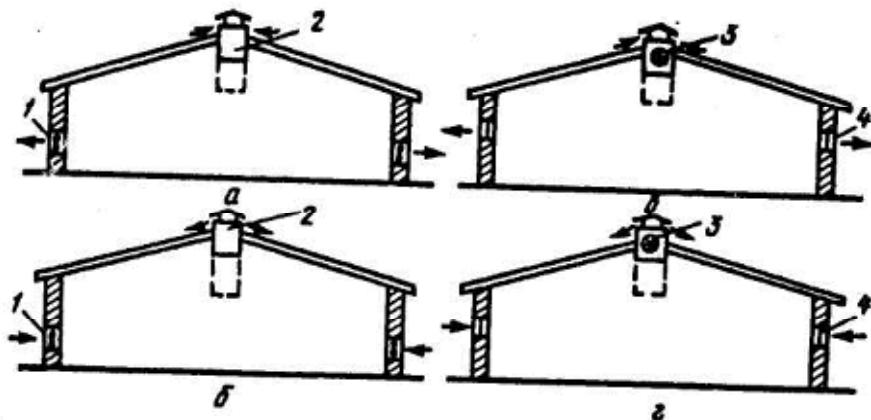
Основные типы летней вентиляции животноводческих помещений: а - вытяжная с настенными вентиляторами; б - приточная с настенными вентиляторами; в - приточная с крышными вентиляторами; г - вытяжная с крышными вентиляторами;
